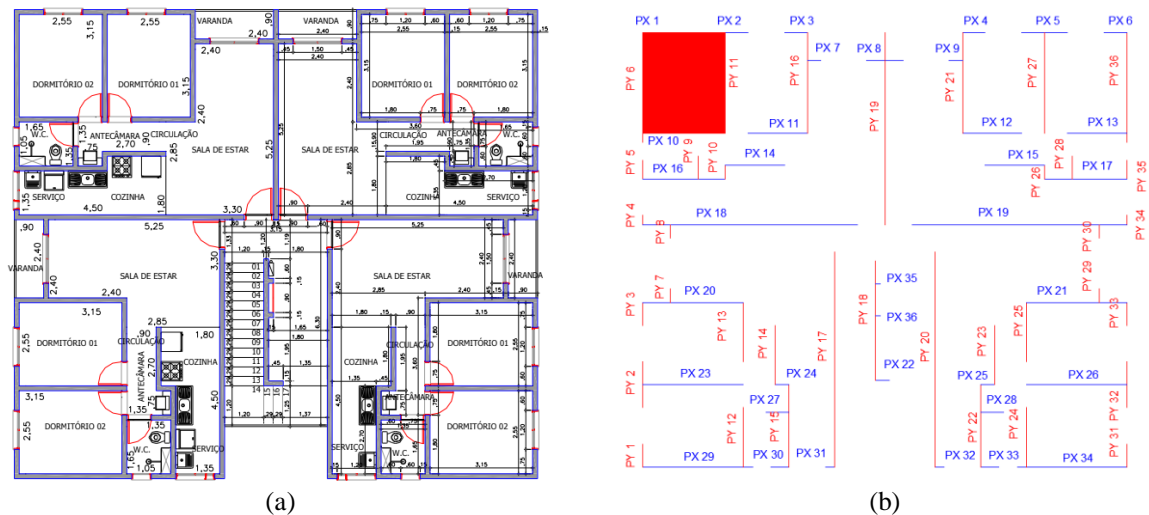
Pavimento tipo do edifício: a) Planta arquitetônica; b) paredes estruturais; (Adaptado de Kleingesinds [7]).
